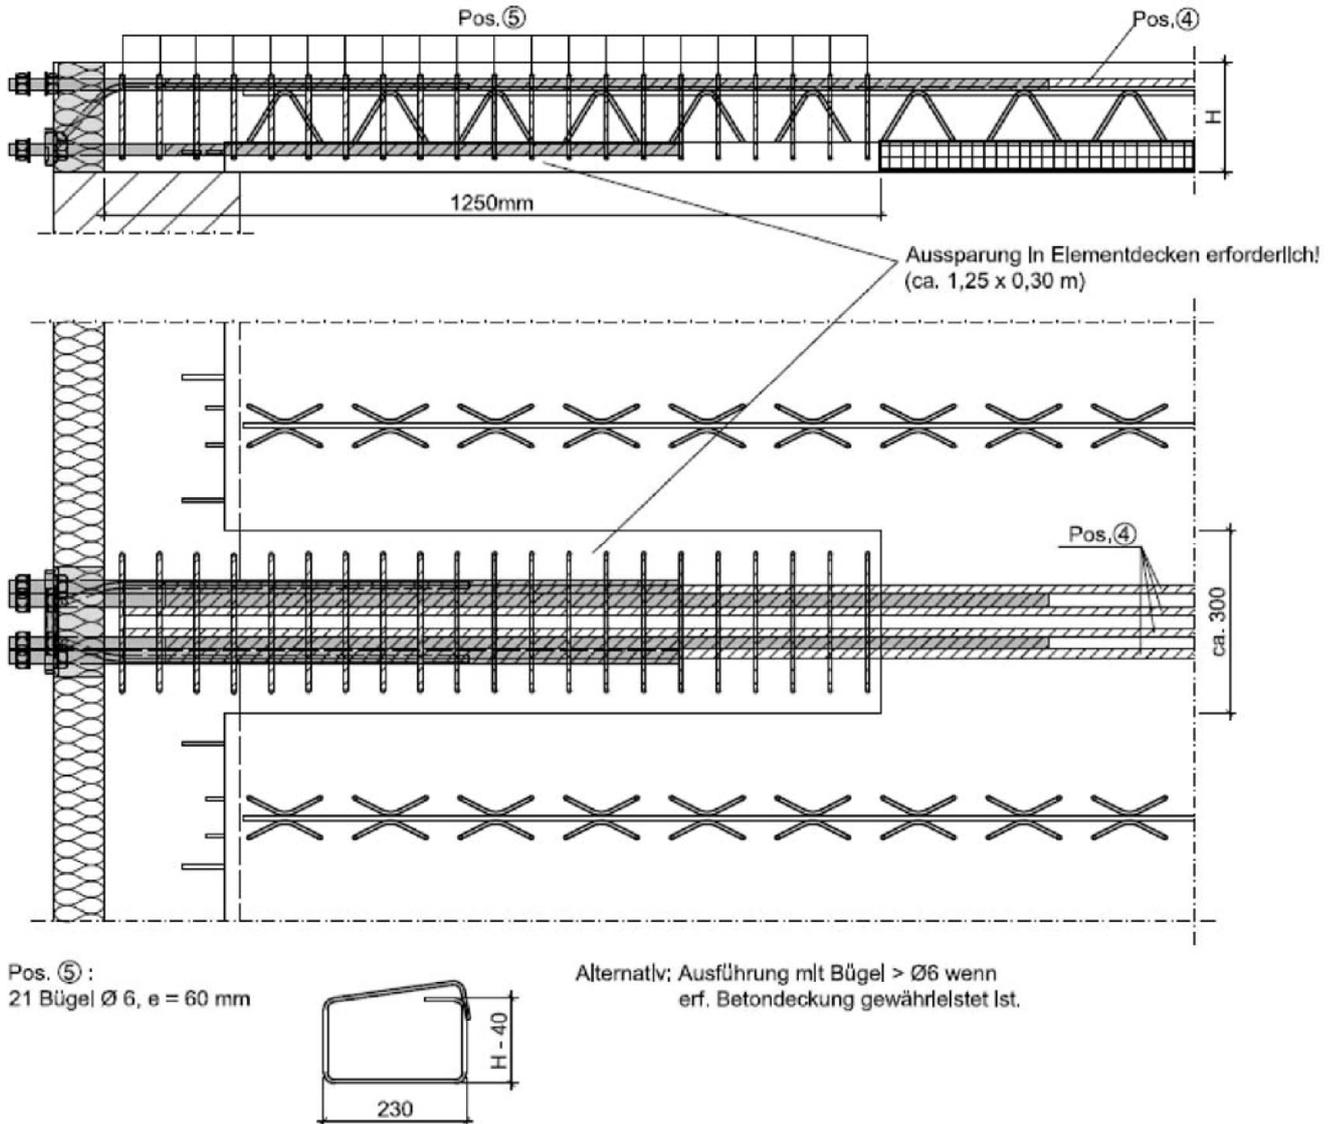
Bauseitige Anschlussbewehrung für Schöck Isokorb® T Typ SK-MM2-VV1 und T Typ SK-MM2-VV2
